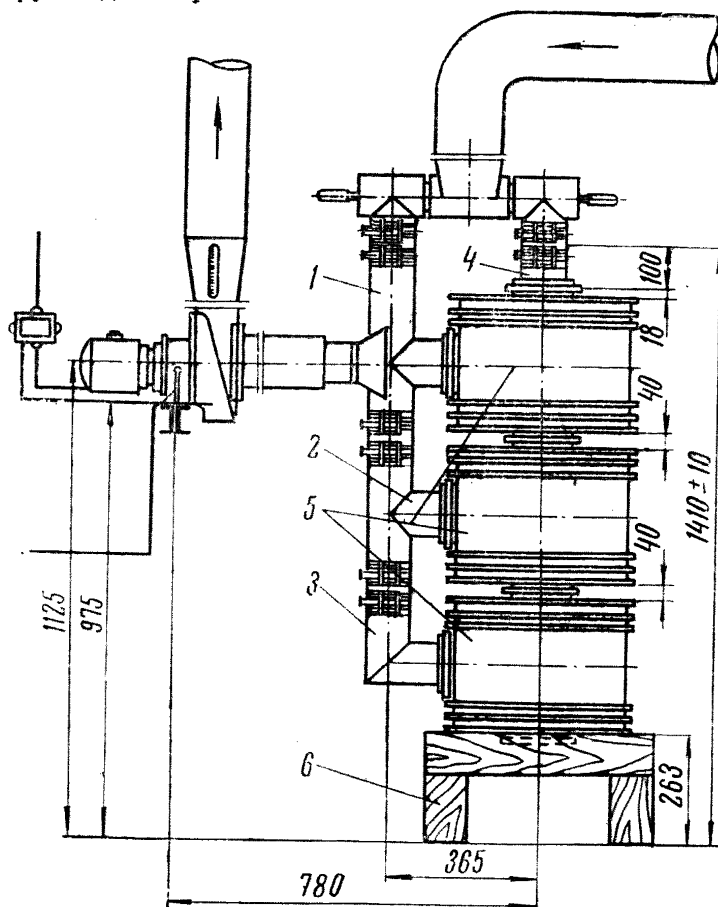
Монтажная схема ФВА-49 с фильтрами-поглотителями ФП-100/50:
